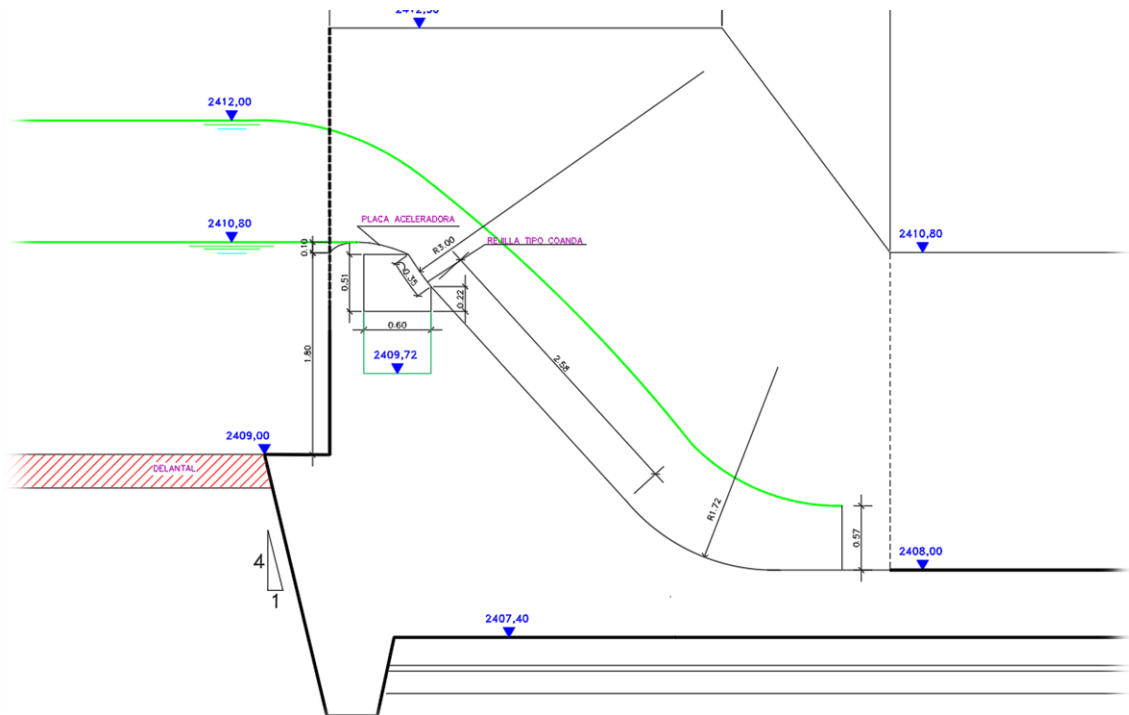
Vista de perfil de la galería de la malla Coanda
